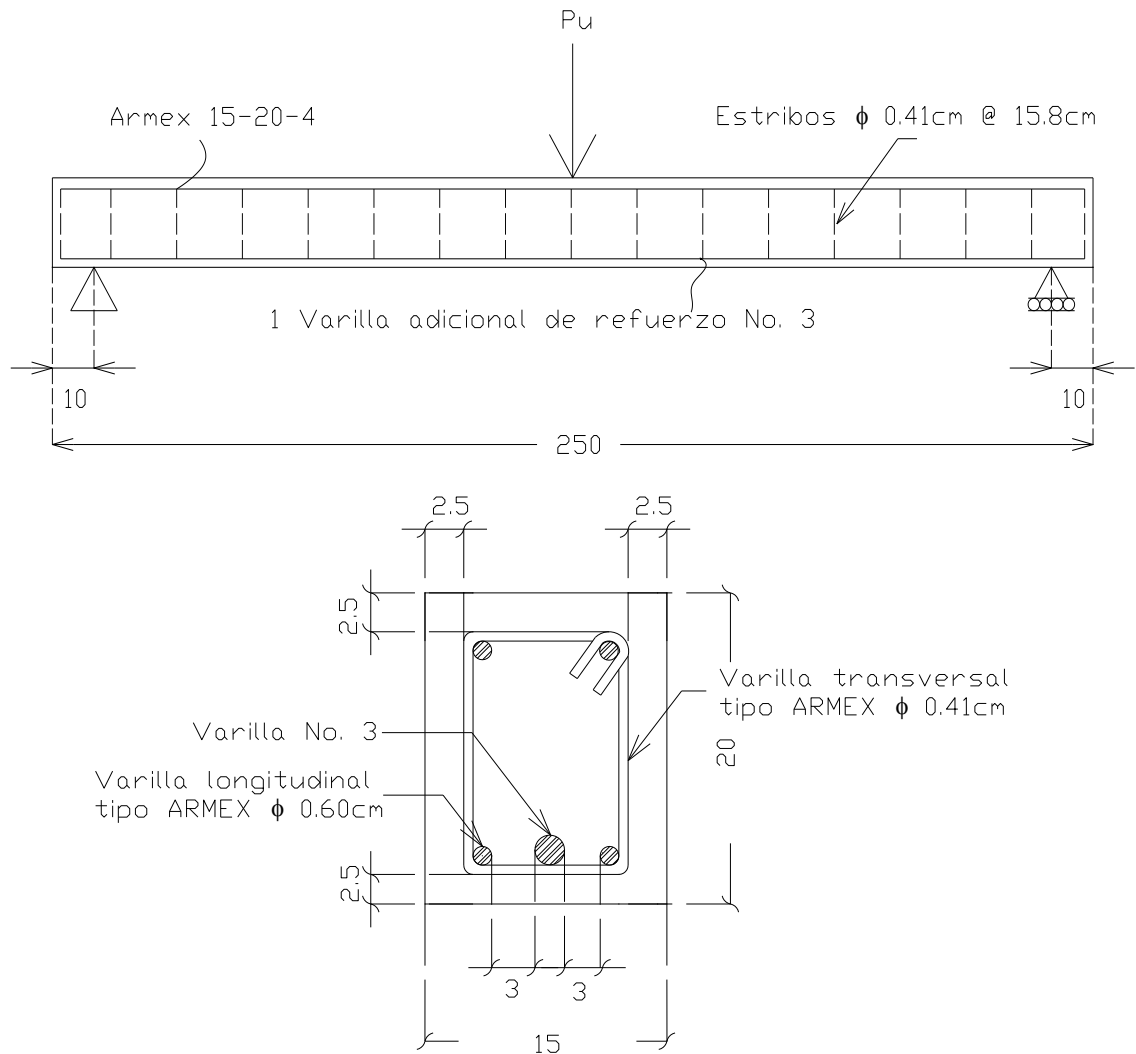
Sección longitudinal y transversal de la viga, acotación en cm.
